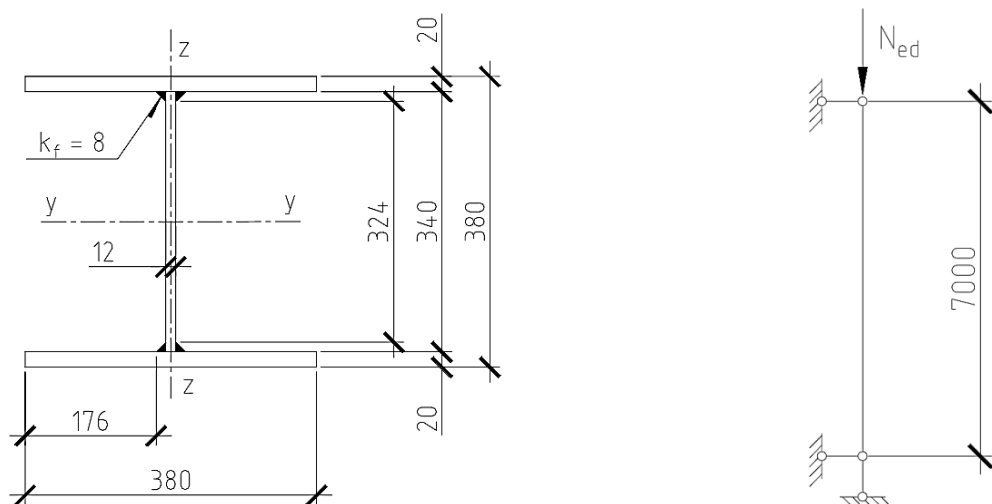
Поперечное сечение стойки и расчетная схема стойки
